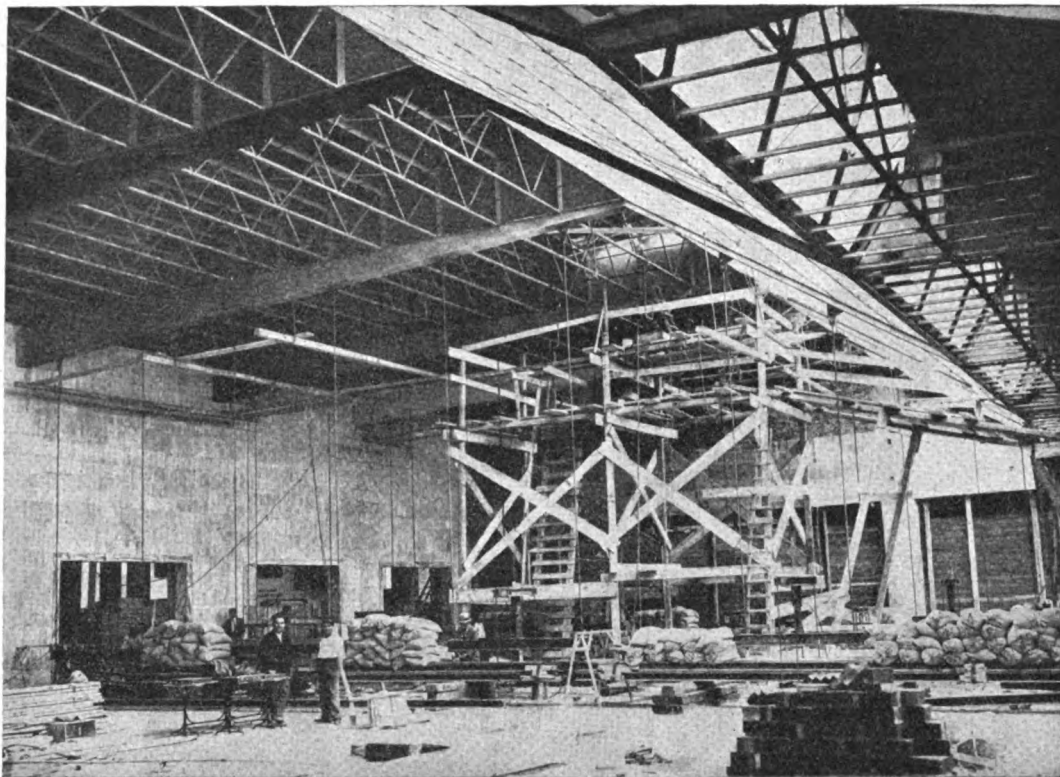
Dispositivo delle prove nelle travi montate in opera.
